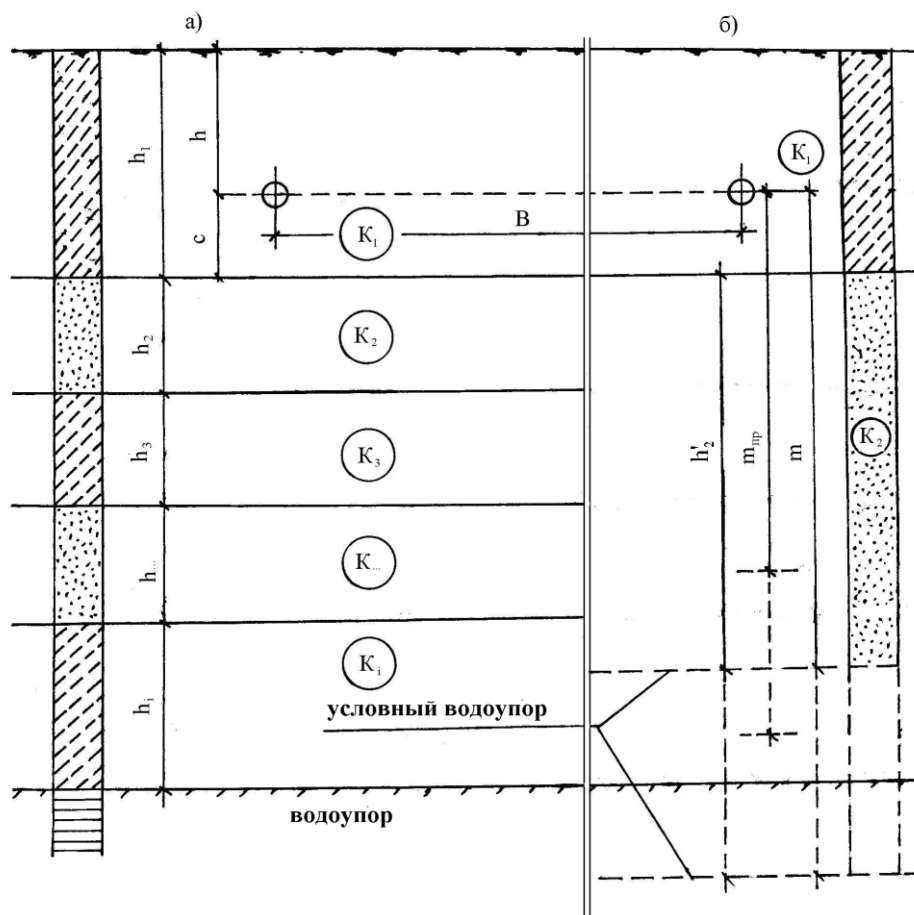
Схема к расчету в условиях напластования грунтов.
